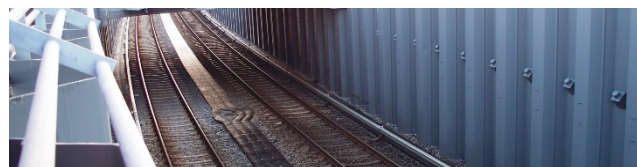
Passage d'une voie ferroviaire en bas de la palplanche
